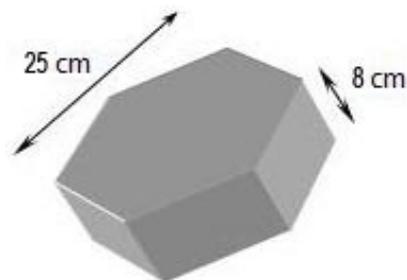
Modelo de Bloco Intertravado do tipo Sextavado com espessura de 8 cm
